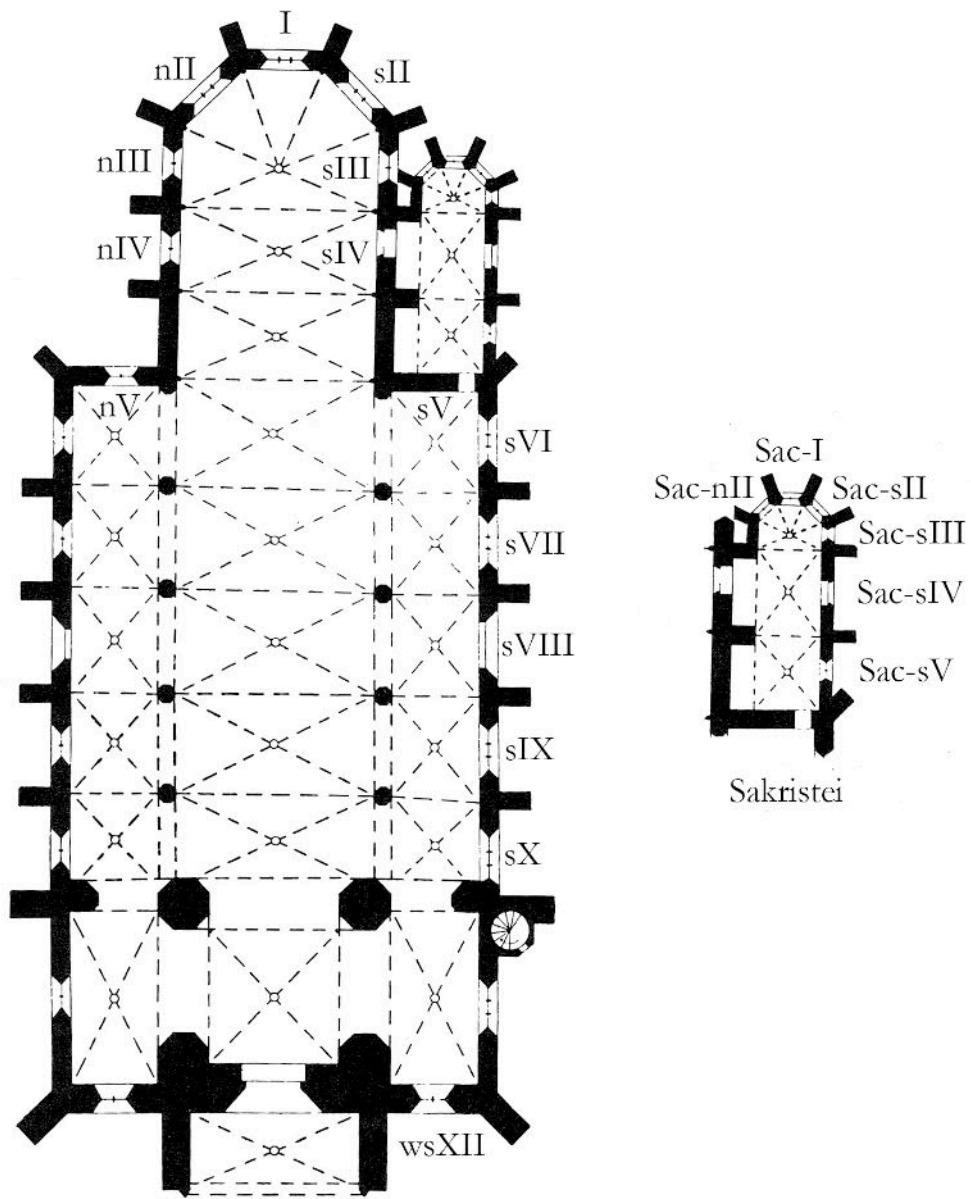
Göttingen, St. Jacobi: Grundriss mit Position der Glasfenster von 1900/1901 und 1925
